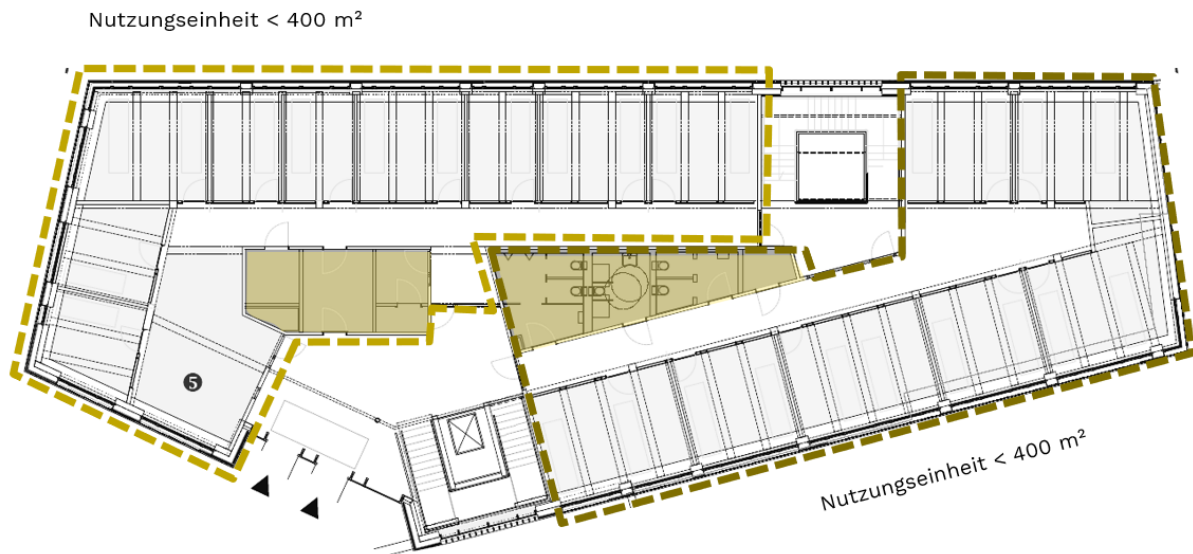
Grundrissstruktur mit Darstellung der 2 Nutzungseinheiten je Geschoss
